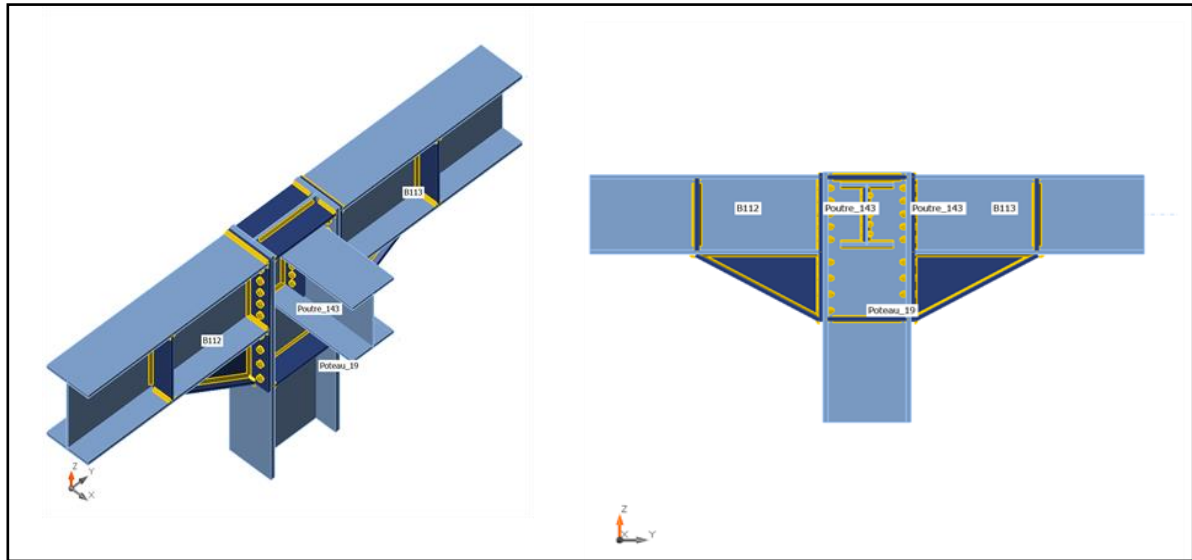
Assemblage poteau de rive – 3 poutres
